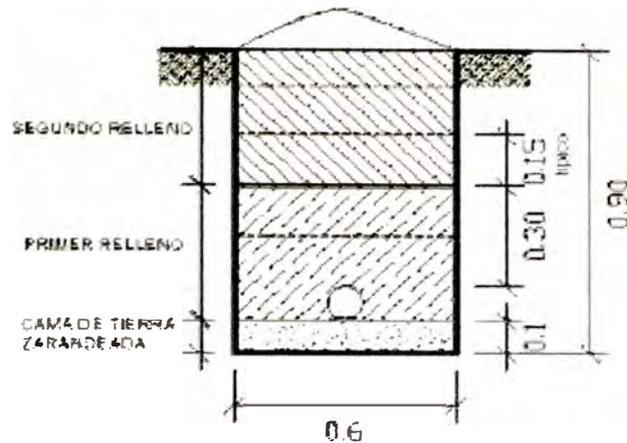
Detalle de zanjas. Fuente: Elaboración propia.
